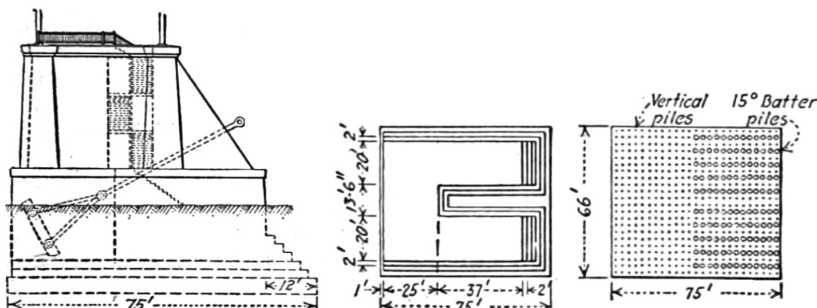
Fundações de concreto nas cabeceiras no continente (C) e na ilha (I).
